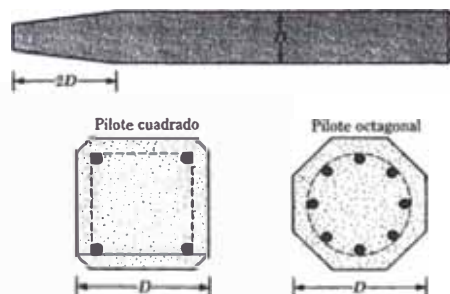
Pilotes prefabricados con refuerzo ordinario.
